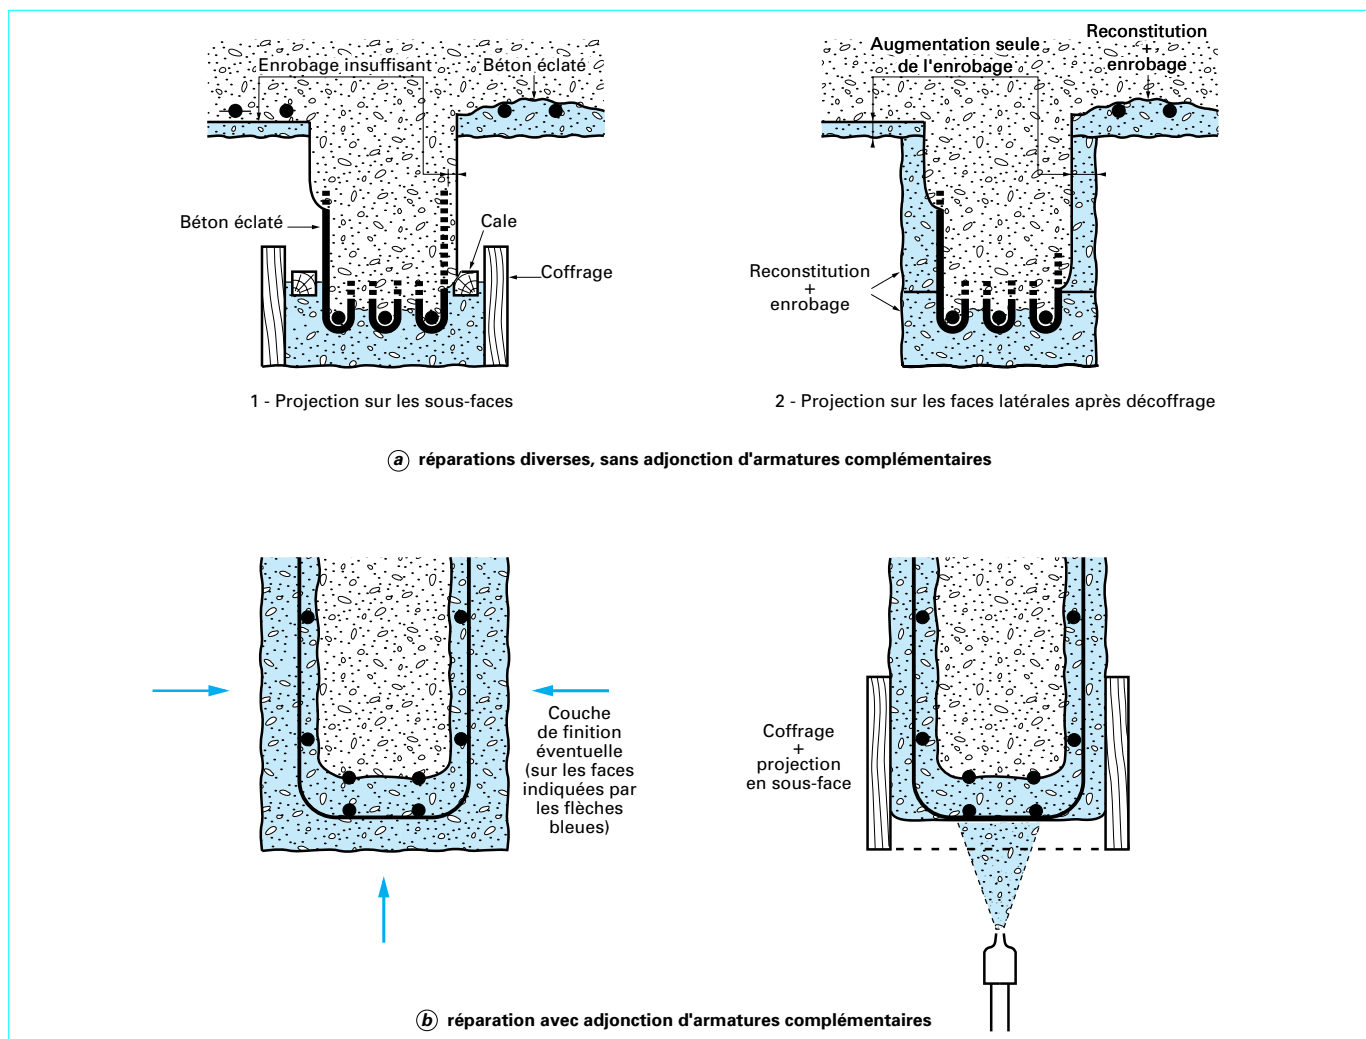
Réparations d'une poutre au moyen de béton projeté
